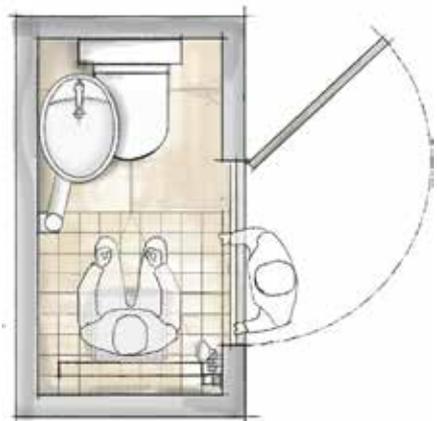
Umbauvariante 4 – Gästetoilette mit Assistenz beim Duschen (Grundriss: DLW)
